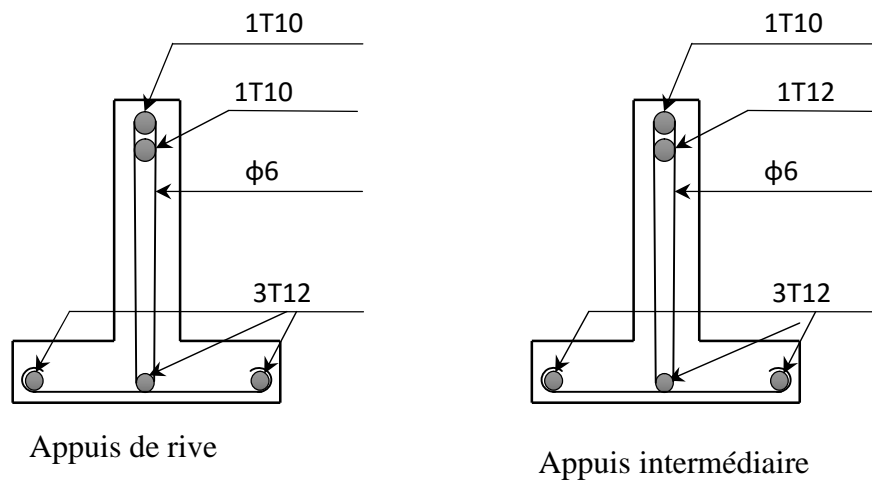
Dessin de ferrailage des poutrelles (étage de terrasse)
